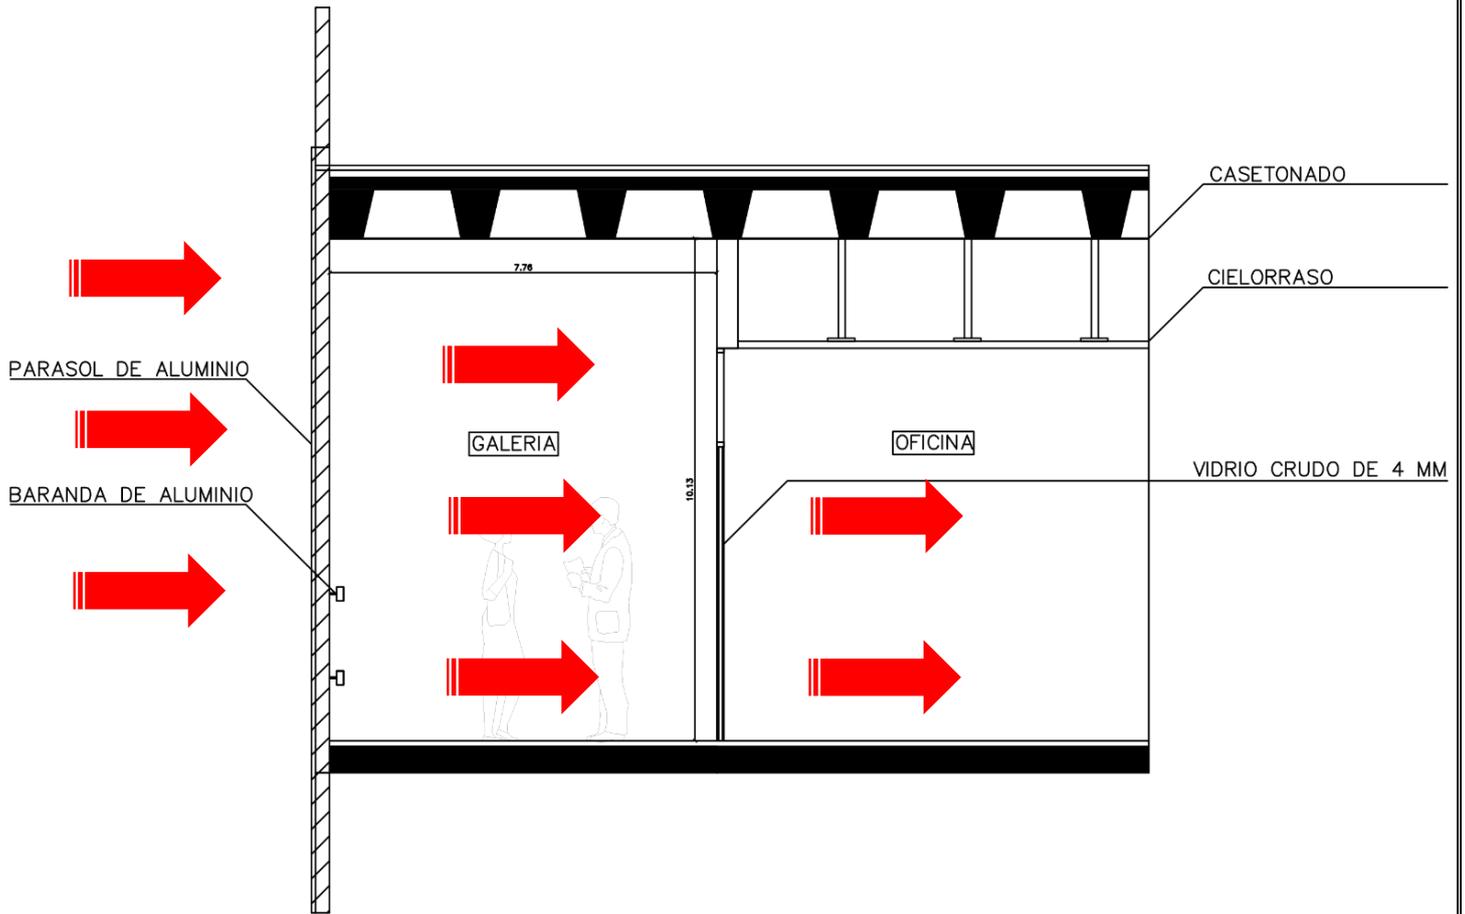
Elaboración propia. Corte longitudinal conexión galerías con oficinas.
